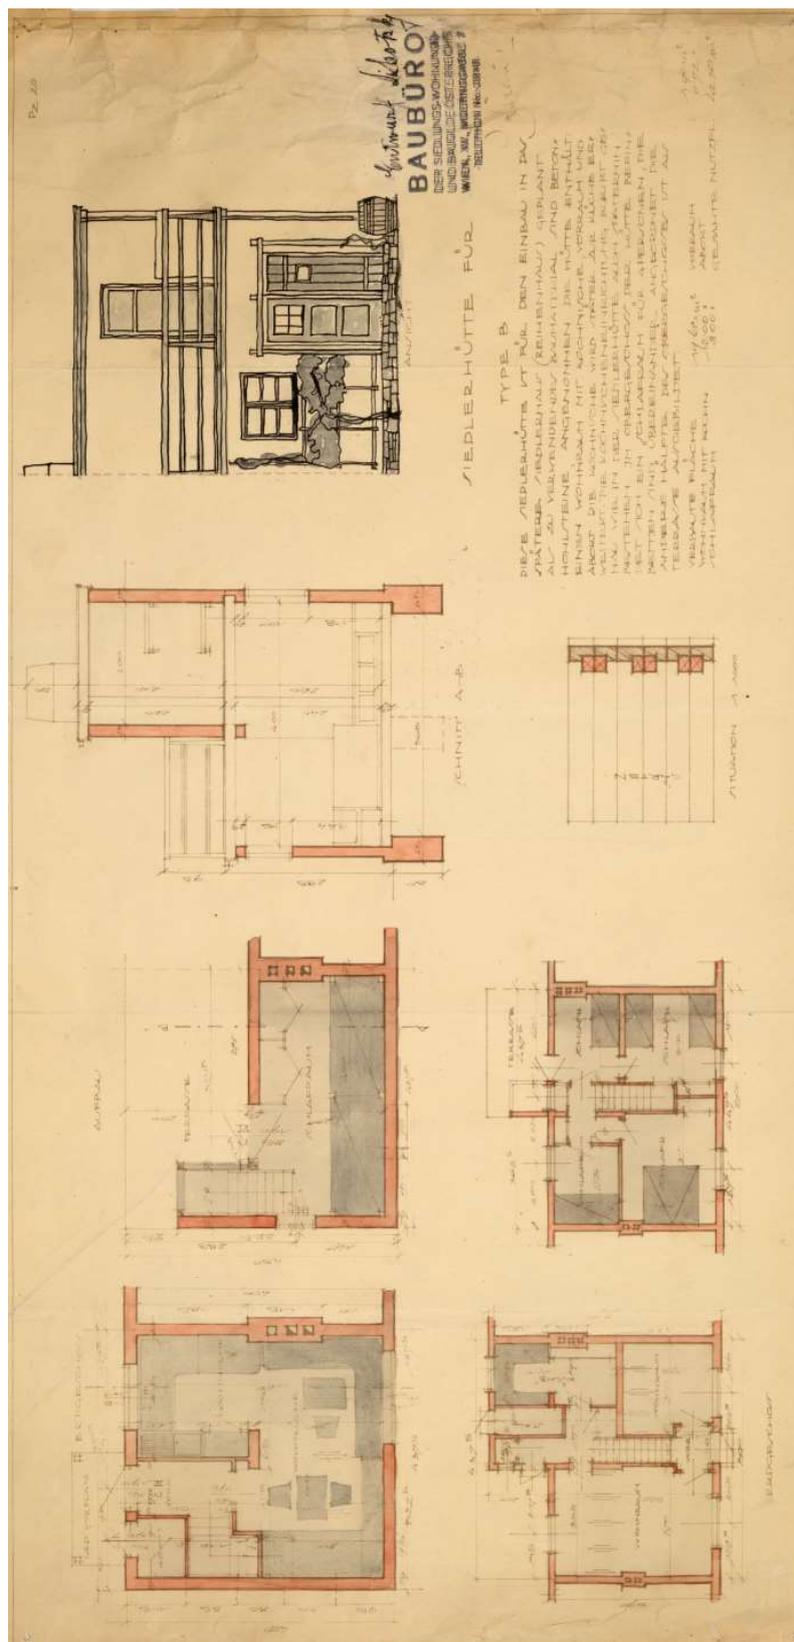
Abb.XLVI:Siedlerhütte Type B, Grundriss, Schnitt und Ansicht. Um 1922.
